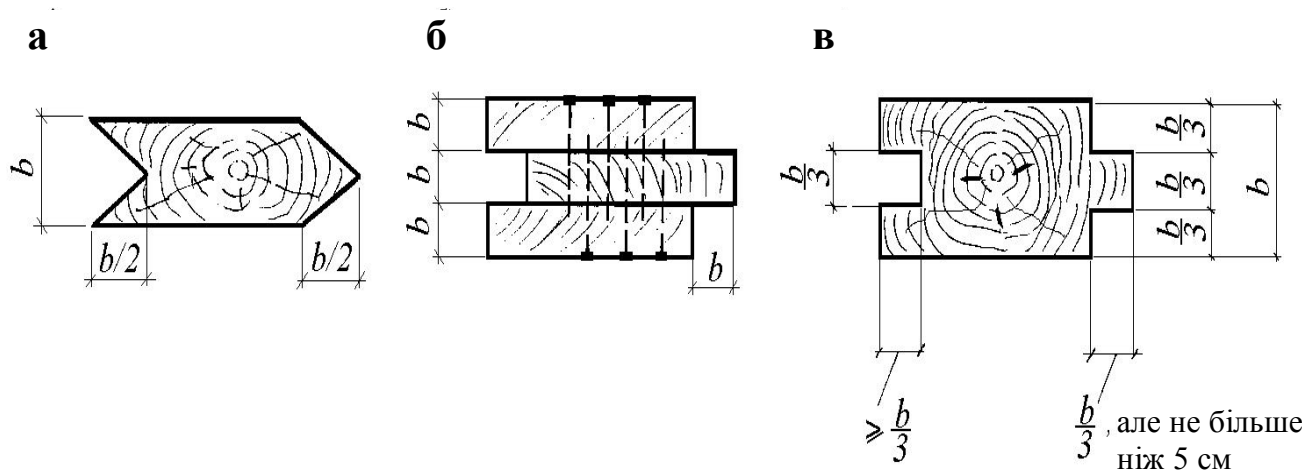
Поперечні перерізи дерев'яного шпунта:
